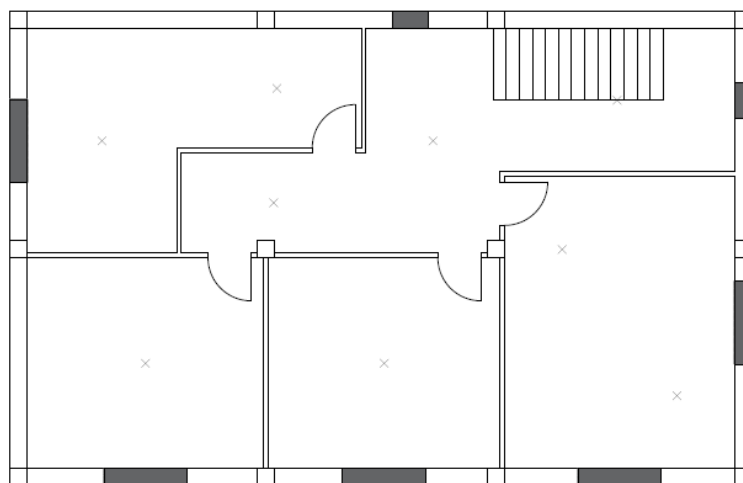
Plano Iluminación de la Vivienda Mejorada primera planta.
